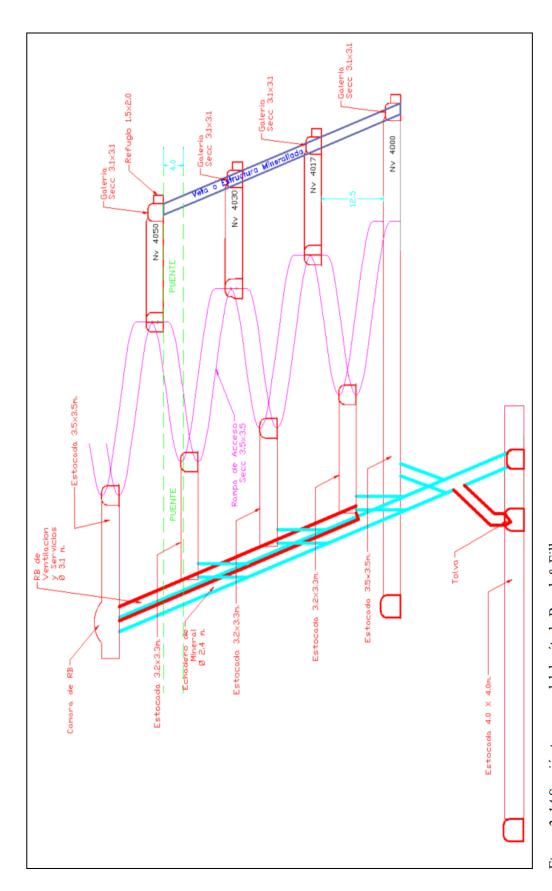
14. Sección transversal del método Bench & Fill utilizado en San Rafael
